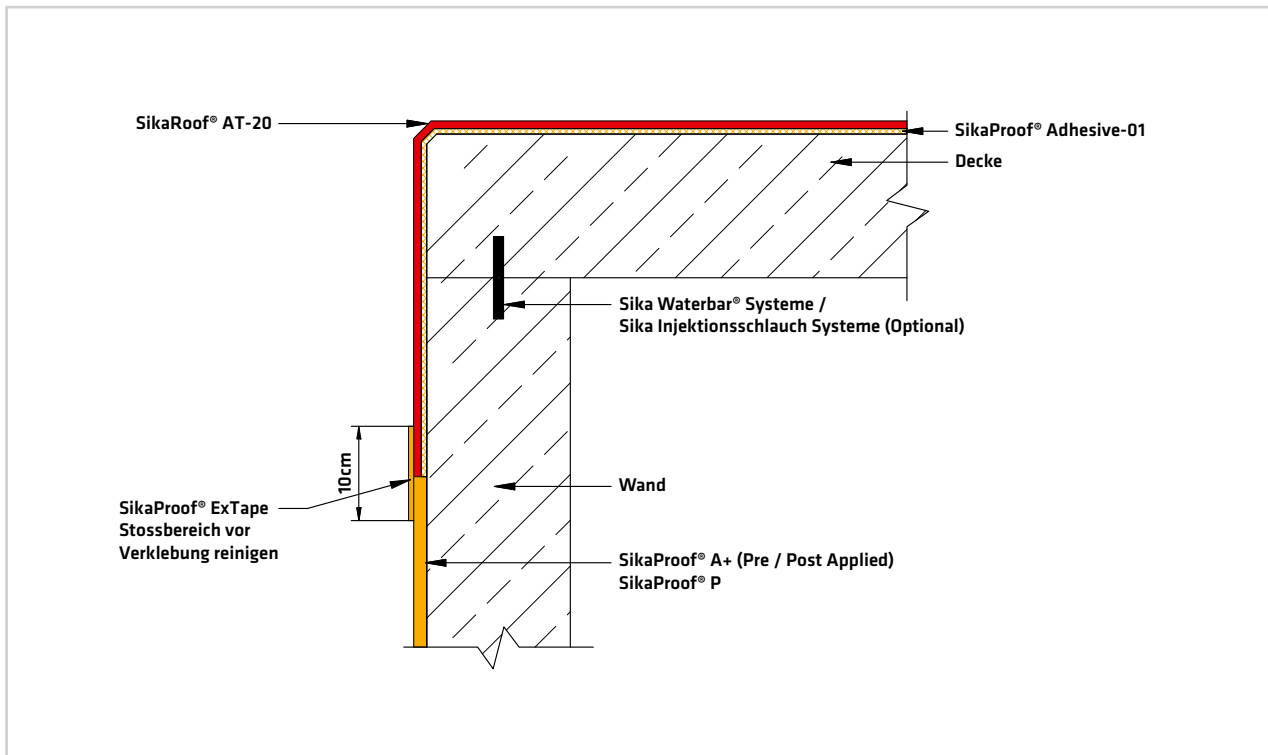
Übergang und Anschluss zu einer Beschichtung oder bit. Flächenabdichtung
